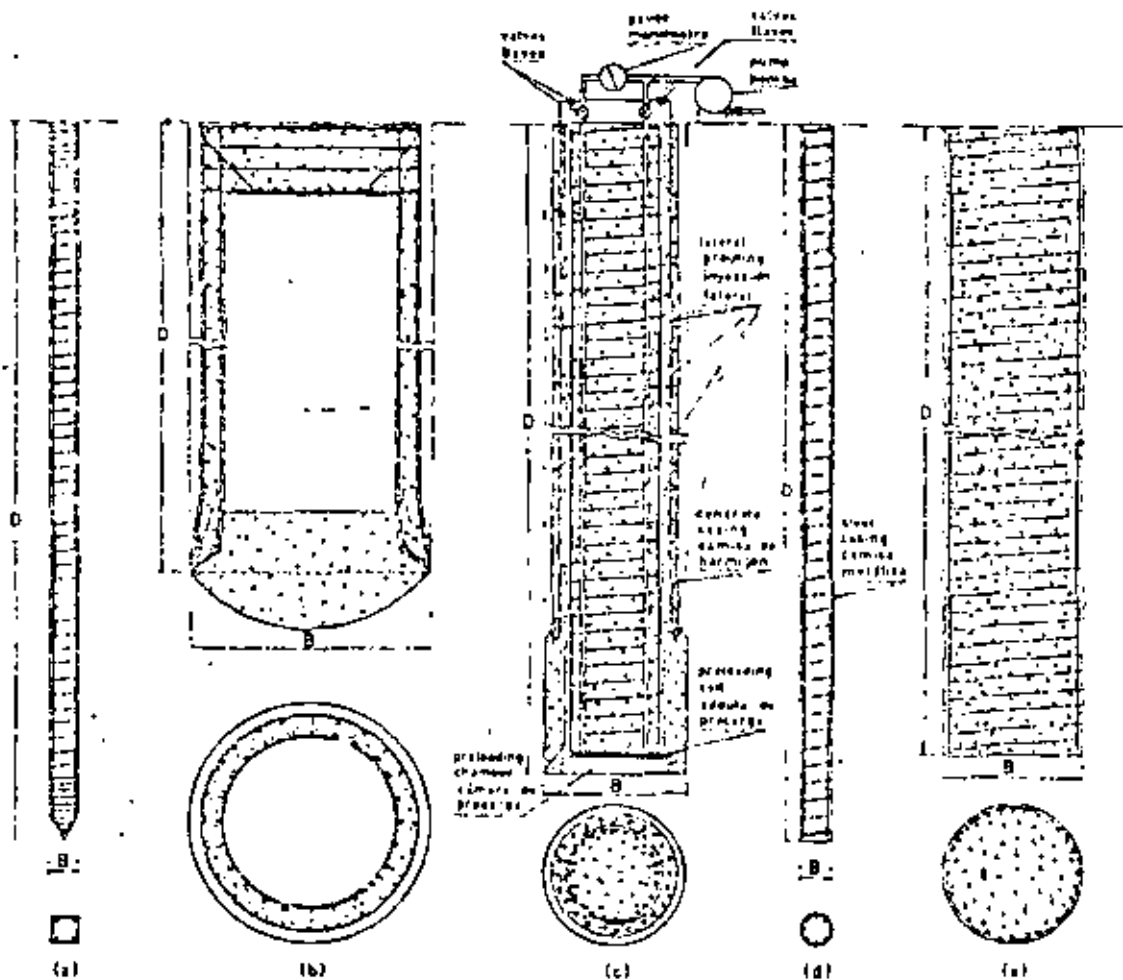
Distintos tipos de fundación profunda: a) pilotes premoldados; b) pilar de fundación; c) pilote de gran diámetro; d) pilote modificado in situ; e) pozo de fundación.
